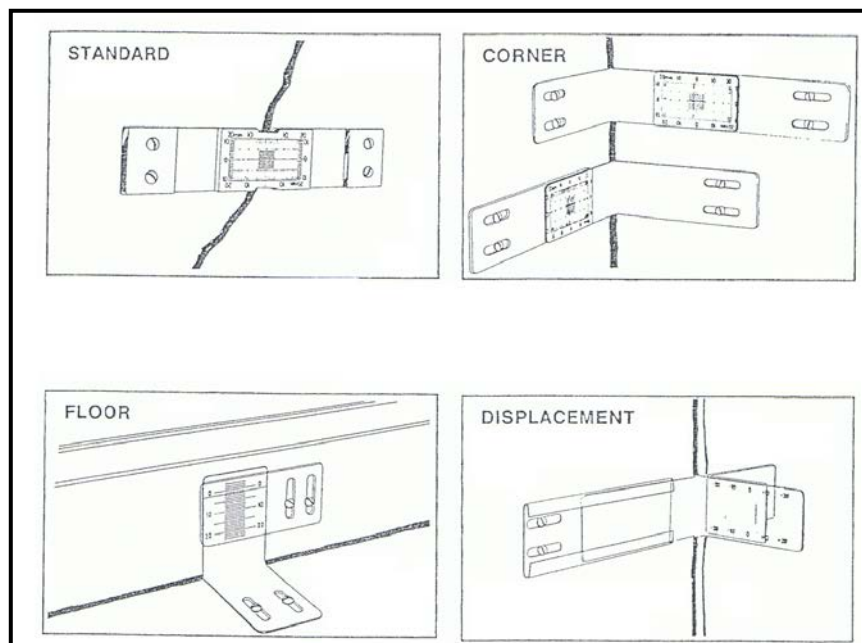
Tipos de fissurômetros "Tell-Tale" (RST Instruments, 1990).
